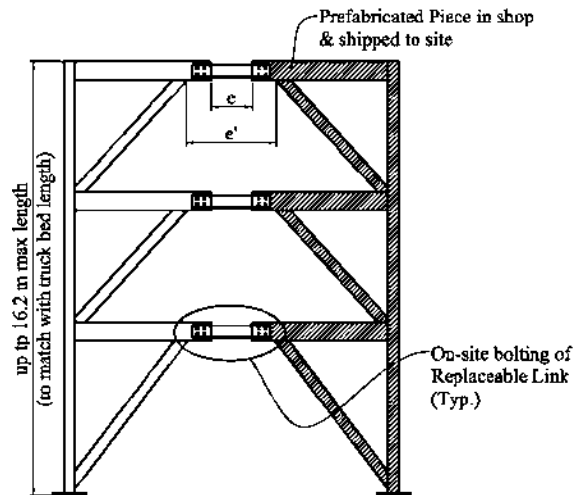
Conexión propuesta con eslabón reemplazable en un MCE con contravientos en K divididos (Mansour; 2010)
